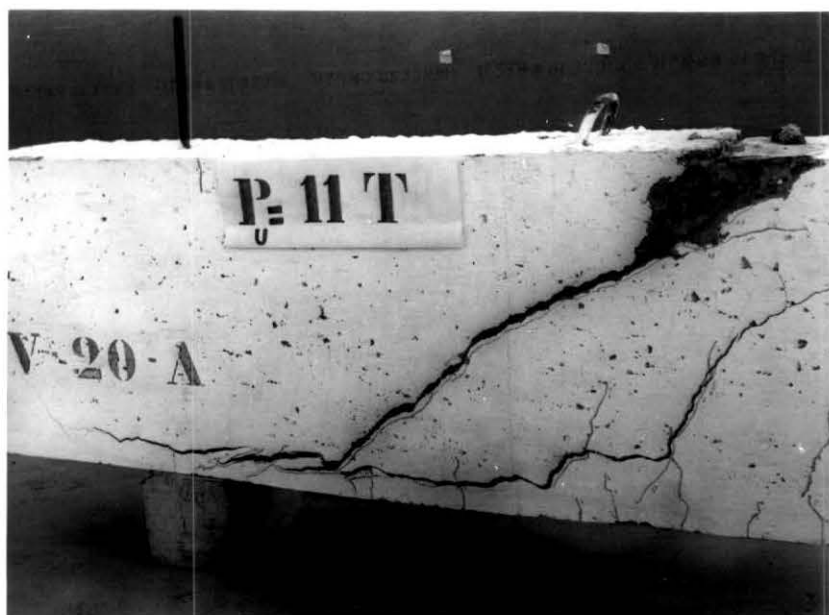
Detalhe da outra face da viga 20A ,notando-se o concreto esmagado na região sob a carga.
